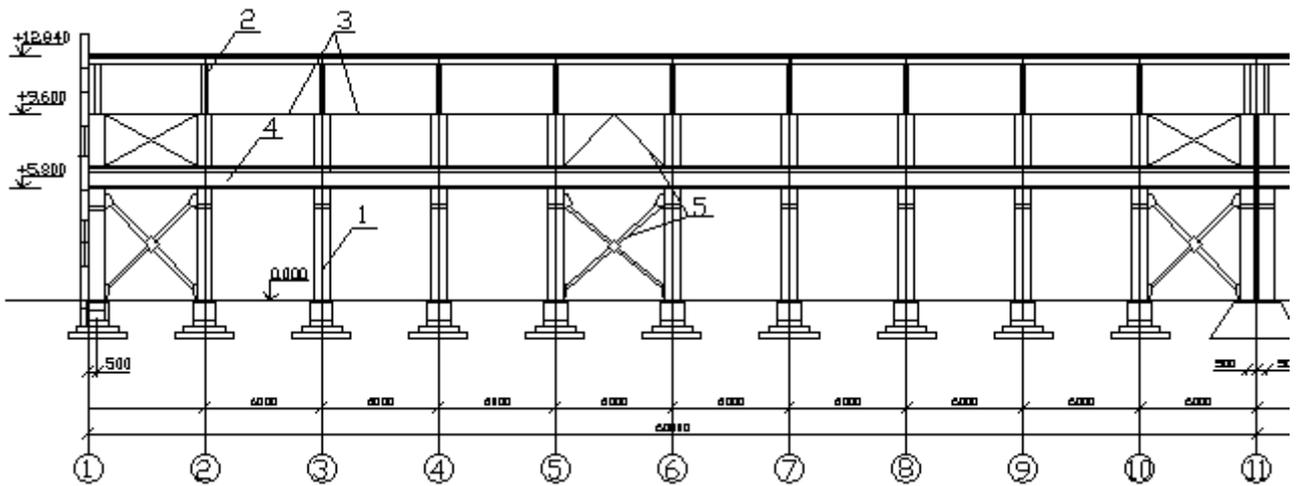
Продольный разрез промздания со связями по колоннам и стропильным конструкциям с привязкой торцевых колонн 500мм. 1-колонна, 2-стропильная конструкция покрытия, 3-обвязочная балка по верху колонны, устанавливается при высоте колонны свыше 14.4 метров, 4-подкрановая балка, 5-связи по колоннам.
